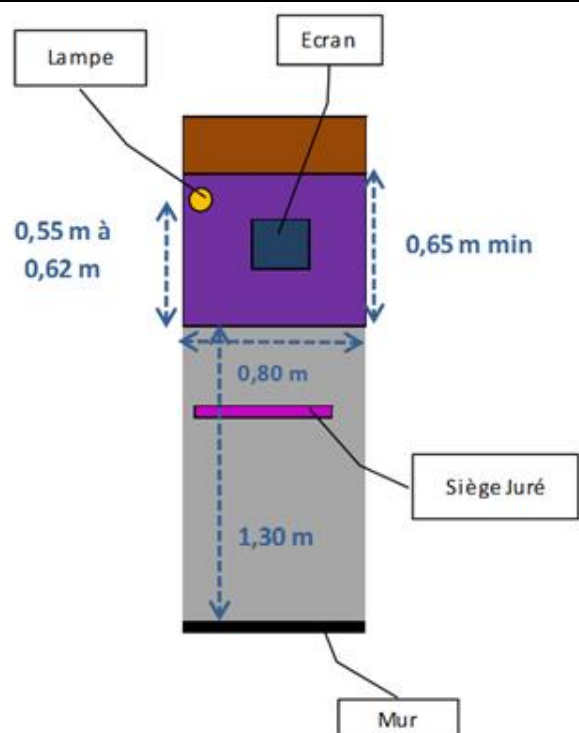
Schéma en plan, position de travail des jurés en salles d'assises
